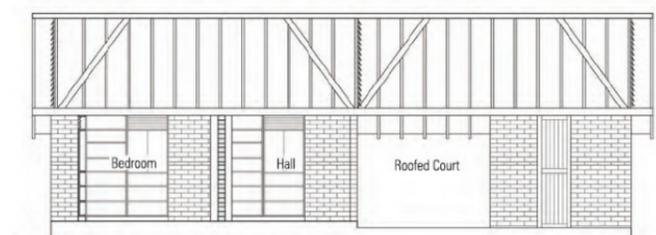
Figura 15. Villaggio di Kirinda. (Fonte: <https://www.archdaily.com/368248/post-tsunami-housing-shigeru-ban-architects>)
